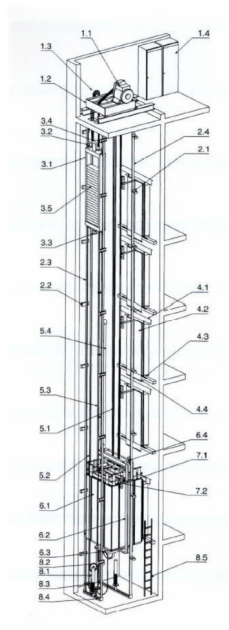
Componentes constituintes de um elevador com casa de máquina
